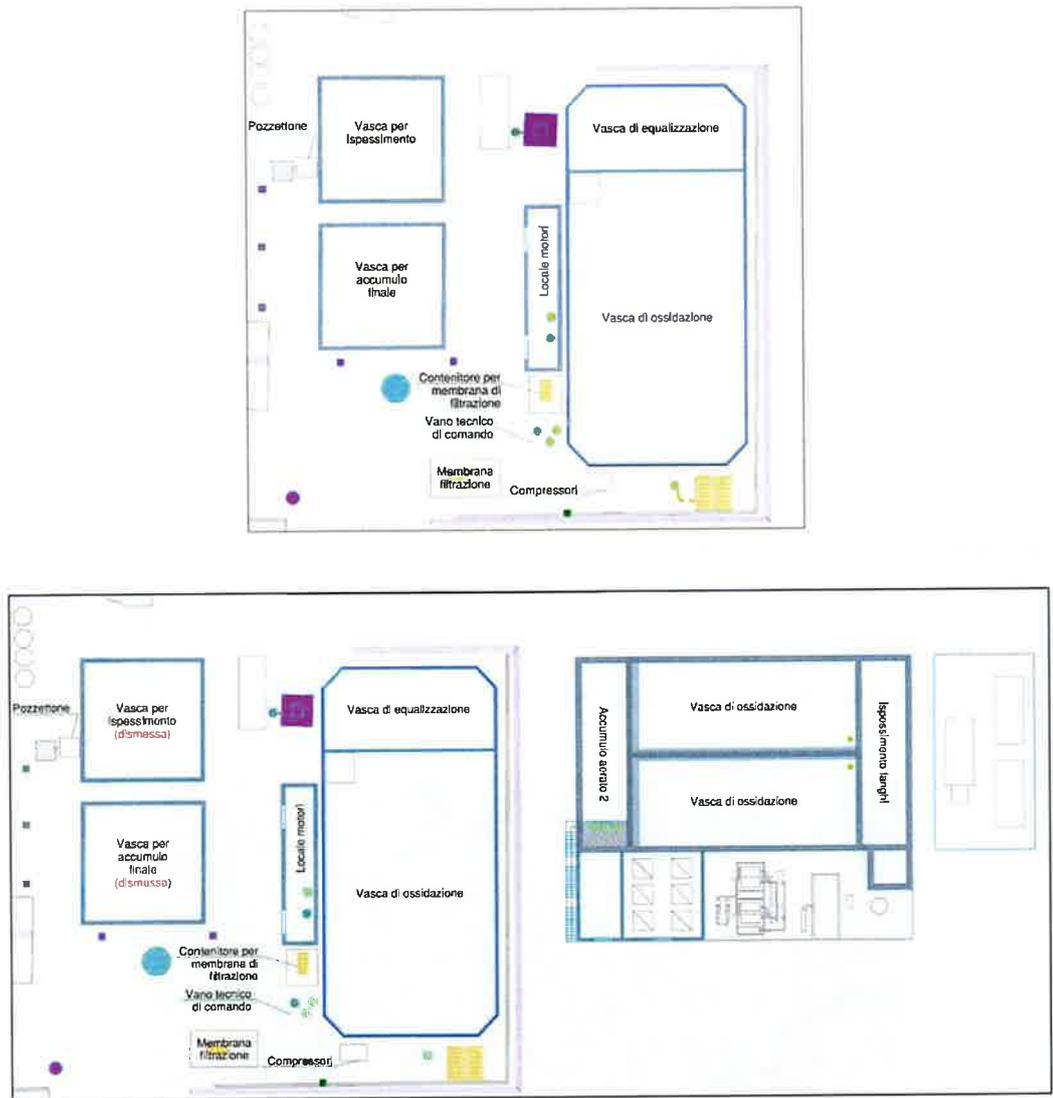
Planimetria dell'impianto di depurazione nella configurazione attuale (SDF - sopra) e nella configurazione di progetto (SDP - sotto).
